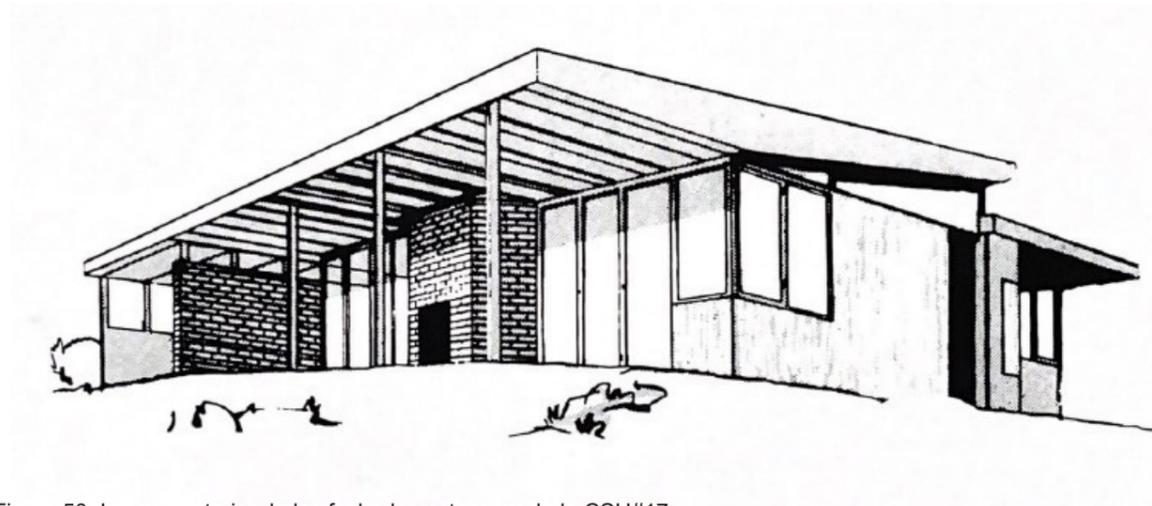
Imagen exterior de las fachadas este y sur de la CSH#17
